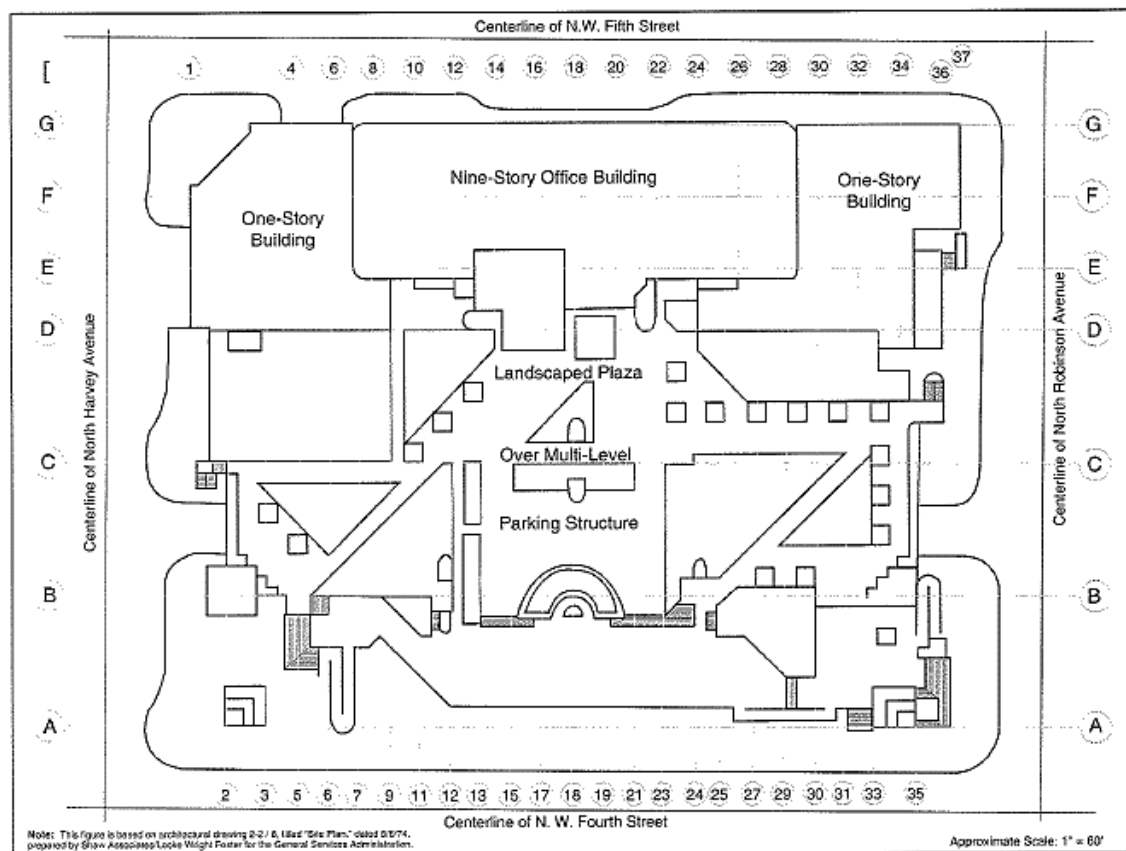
Planta esquemática de la distribución del complejo Alfred P. Murrah.[22]
